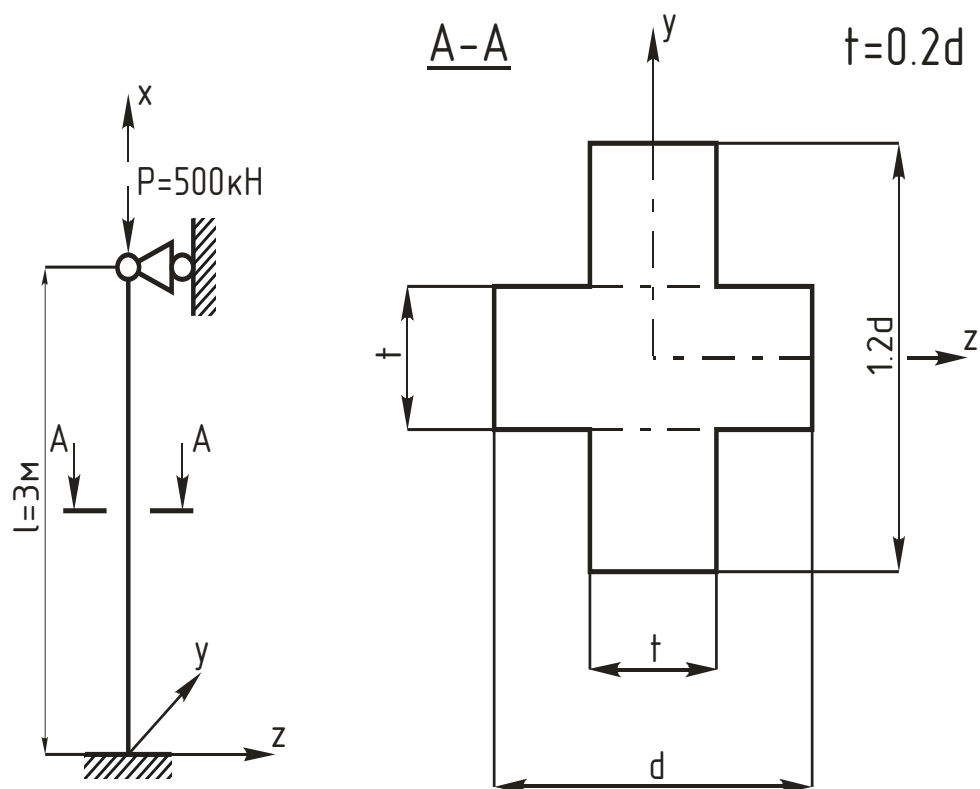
Схема к определению размеров поперечного сечения стержня
